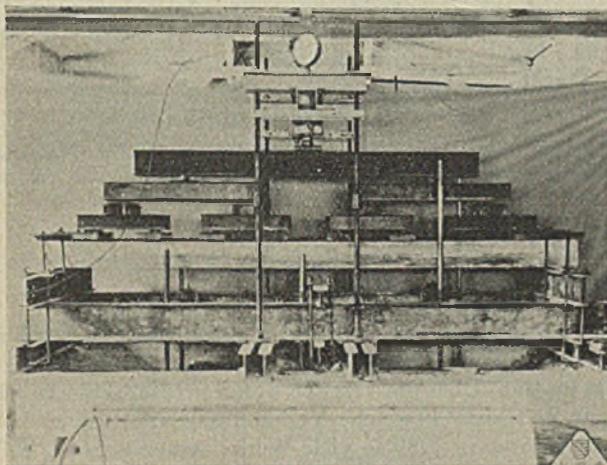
zeigt den Prüfstand des Materialprüfungsamtes Dresden mit einem eingesetzten Stahlsaitenbetonträger vor dem Belastungsversuch.
